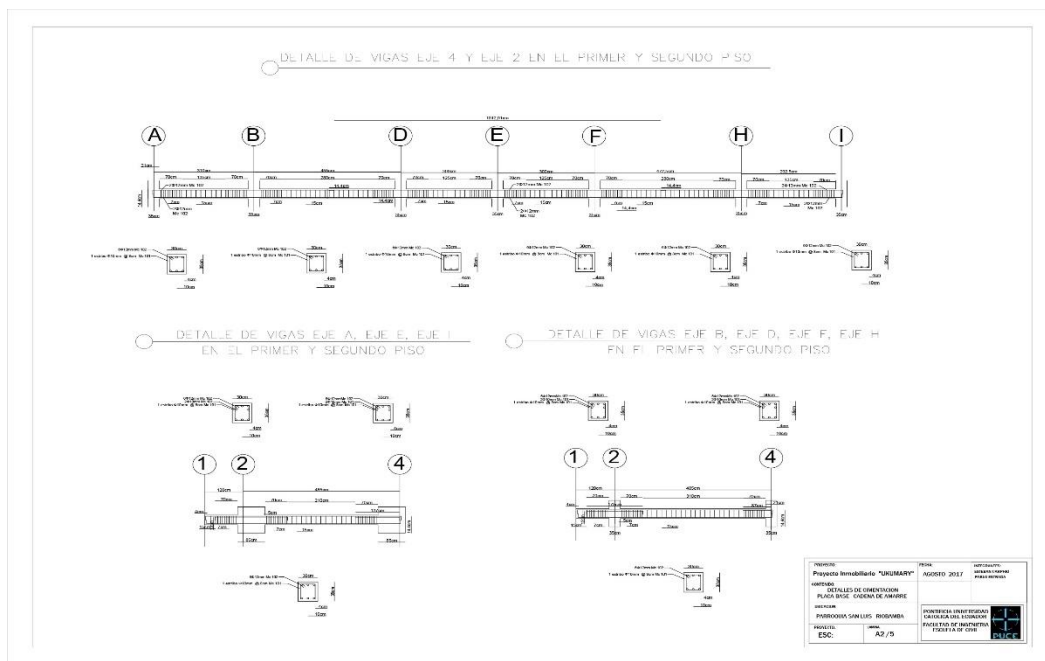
Detalle de planos estructurales - vigas– Fuente: Carphio (2017)
